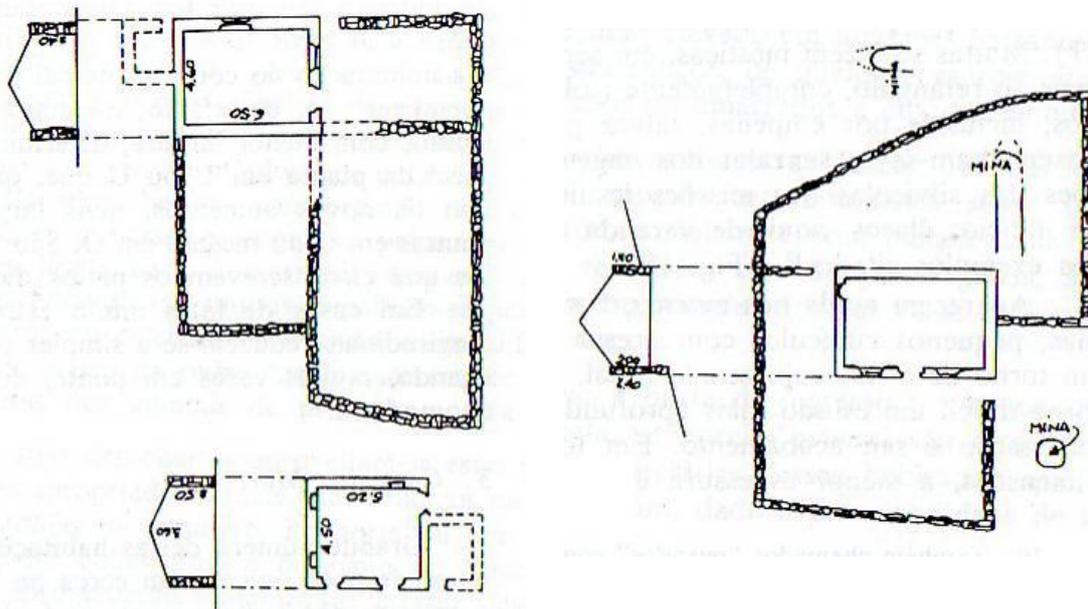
Exemplo de planta baixa semelhante às *casas de morros* e aos *ranchos*.
